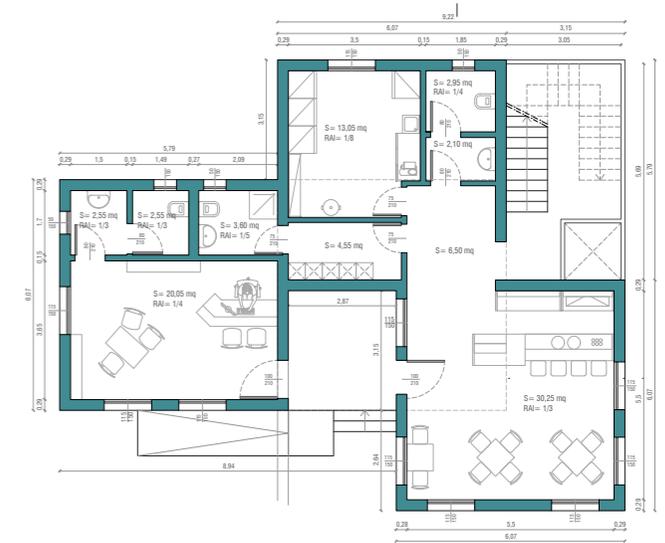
Pianta piano terra. Scala 1:200
